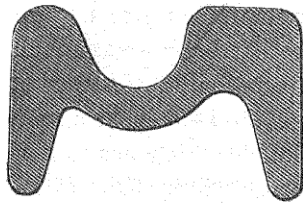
Section du rail entre Sèvres et Versailles. 16 kil. par mètre courant. Échelle 1/2.
